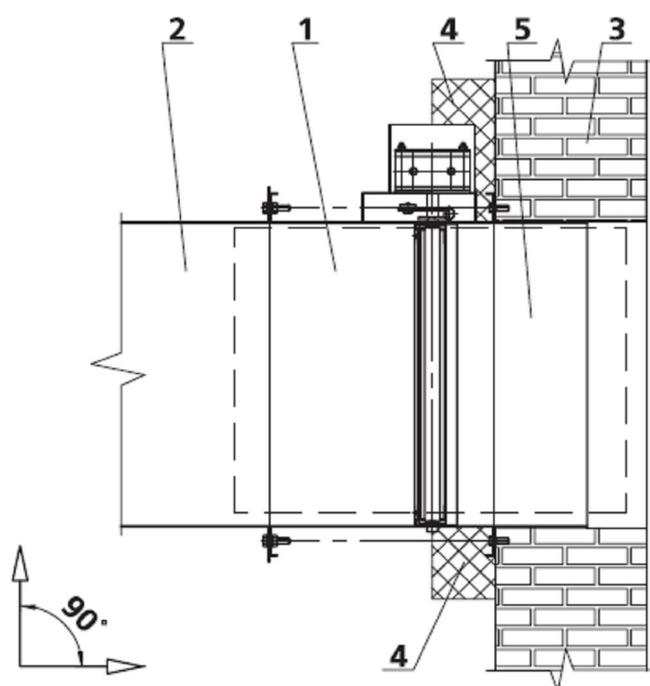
Монтаж клапана, присоединяемого к стене с использованием монтажной рамы: 1 – клапан; 2 – воздуховод; 3 – стена; 4 – наружная теплозащита; 5 – монтажная рама
